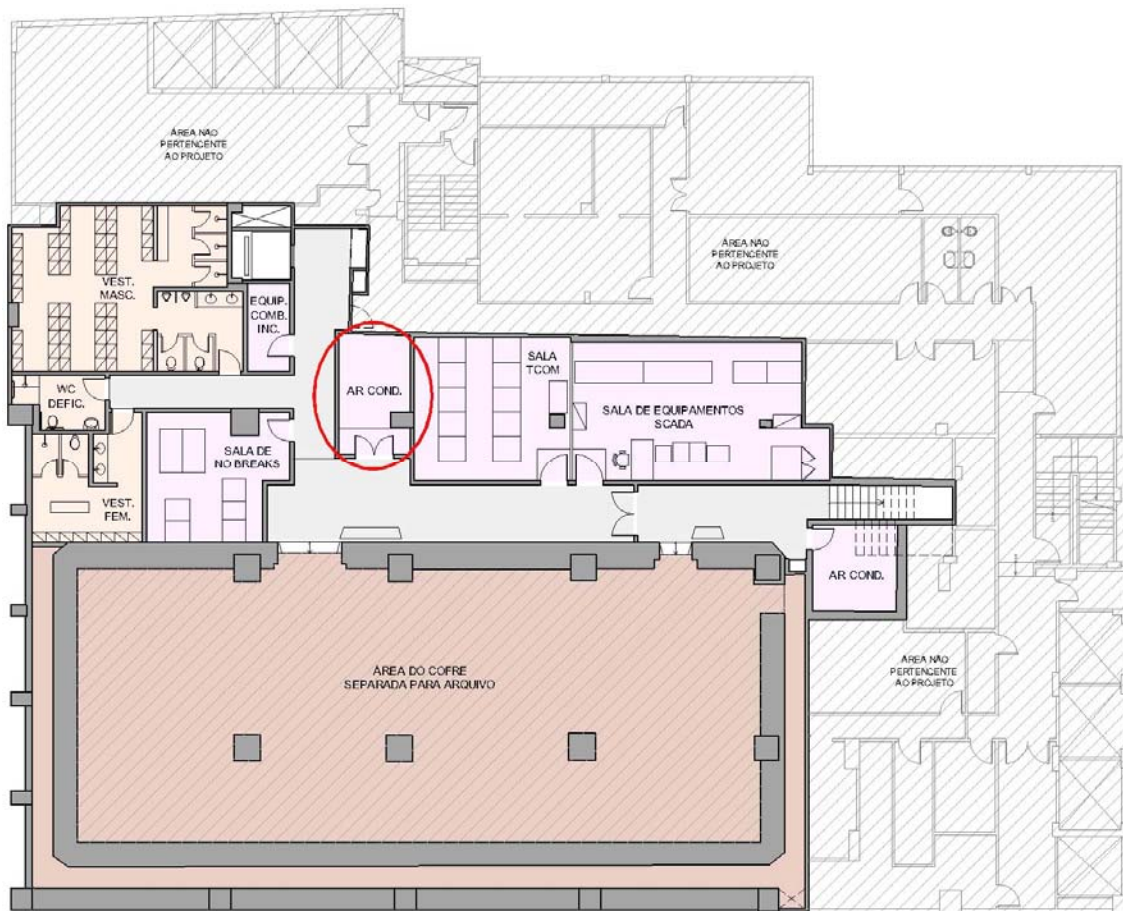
Planta baixa subsolo: layout apresentado como revisão do *milestone 2
